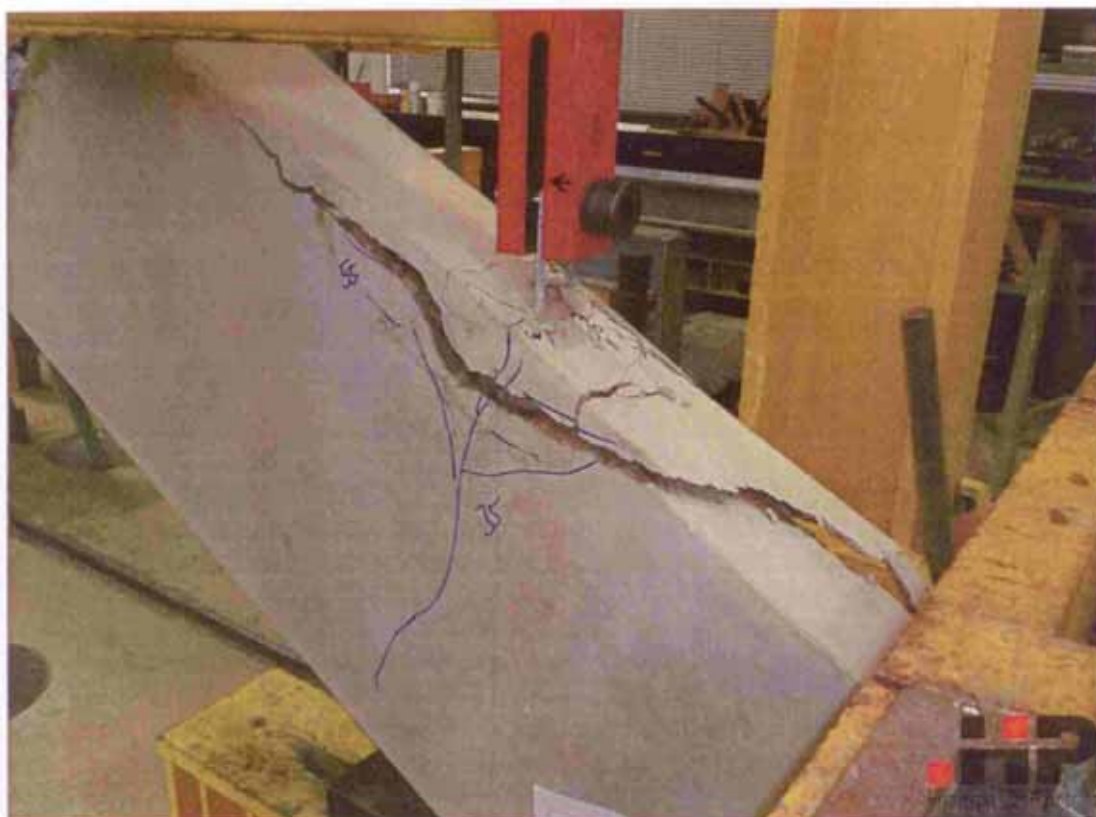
Großflächige Betonablösungen nach Erreichen der Maximallast
